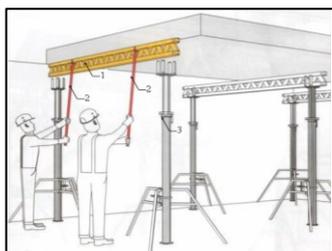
Демонтаж балок настила опалубки: 1 – продольная балка; 2 – монтажная штанга; 3 – основная стойка
